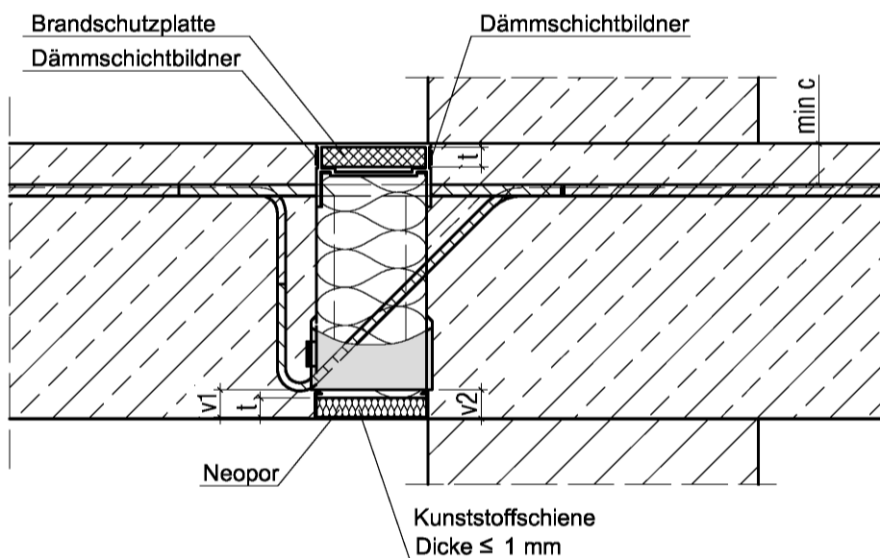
Schöck Isokorb® Typ K und Typ KF (Ausführungsvariante C) gem. Abschnitt 3.1.2
